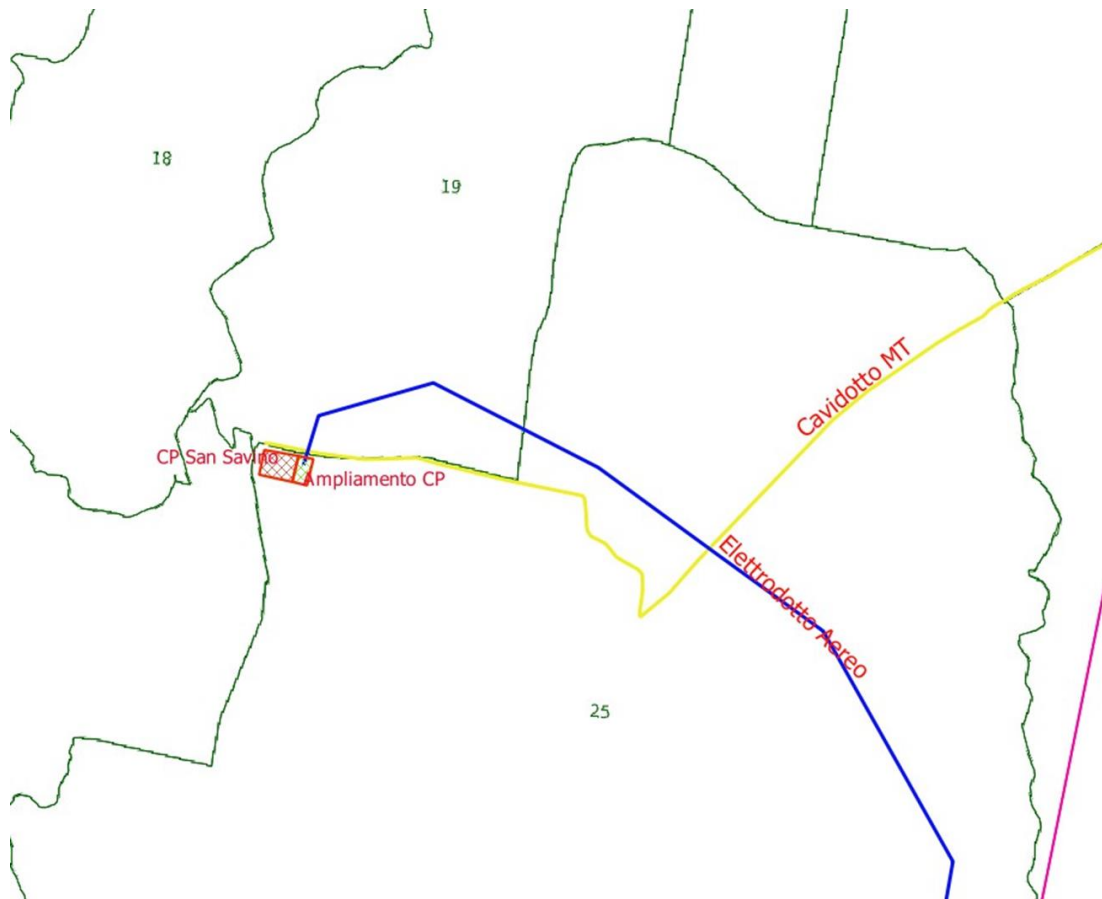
Stralcio Fogli planimetria catastale con area cabina primaria CP San Savino
